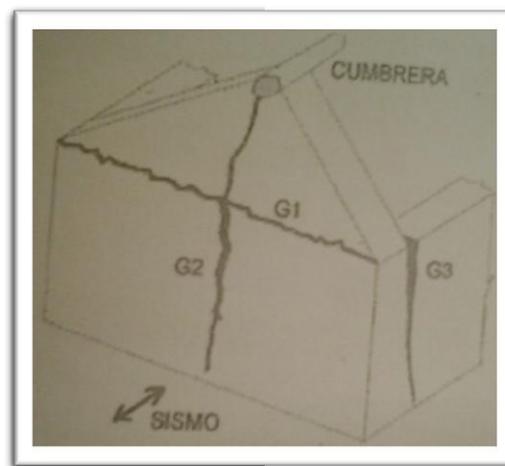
Grietas en los Muros por Acciones Sísmicas Perpendiculares al Plano
